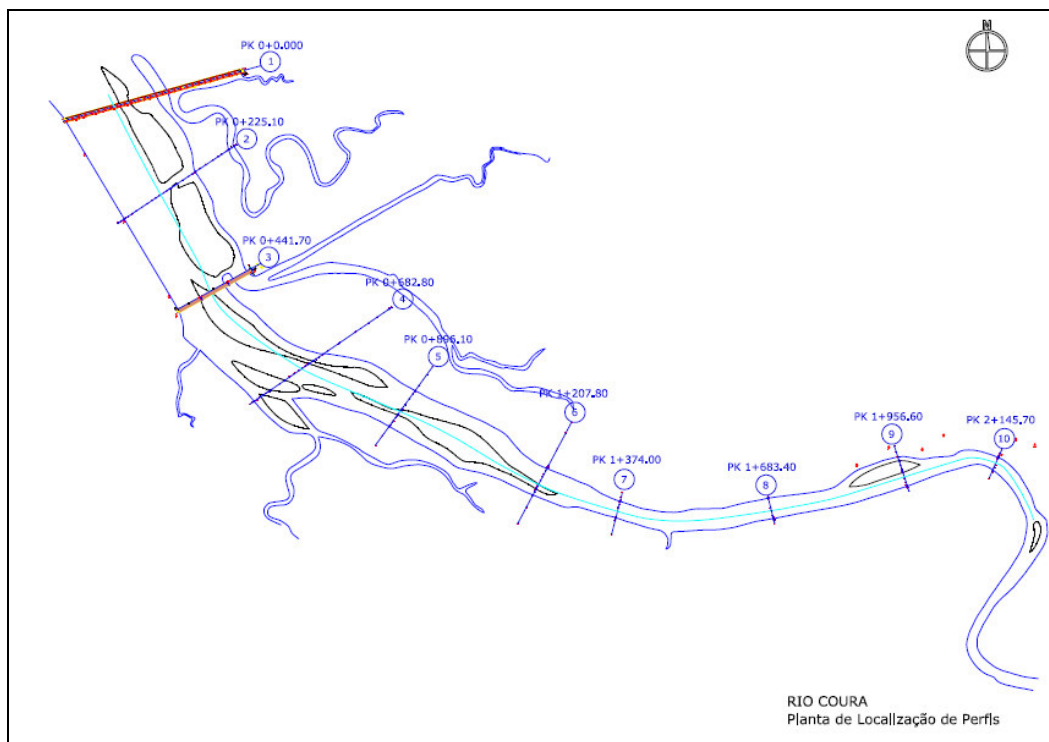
Traçado do rio Coura em planta com as secções transversais consideradas (1 a 10).
